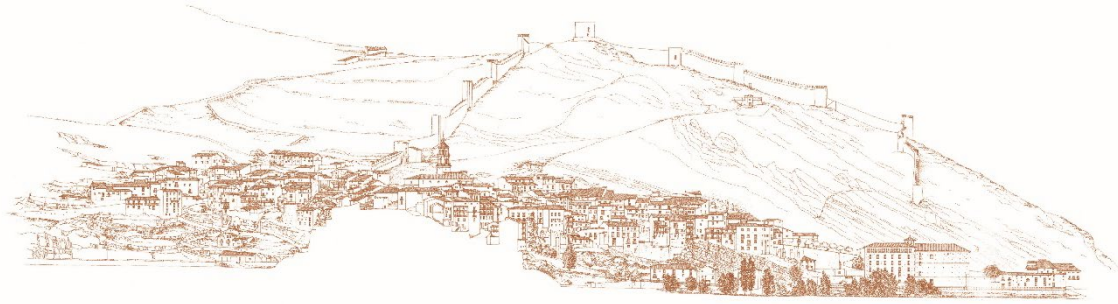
Alzado Sur de la ciudad de Albarracín, levantado por fotogrametría. Fuente: (Almagro, 1987), detalle
